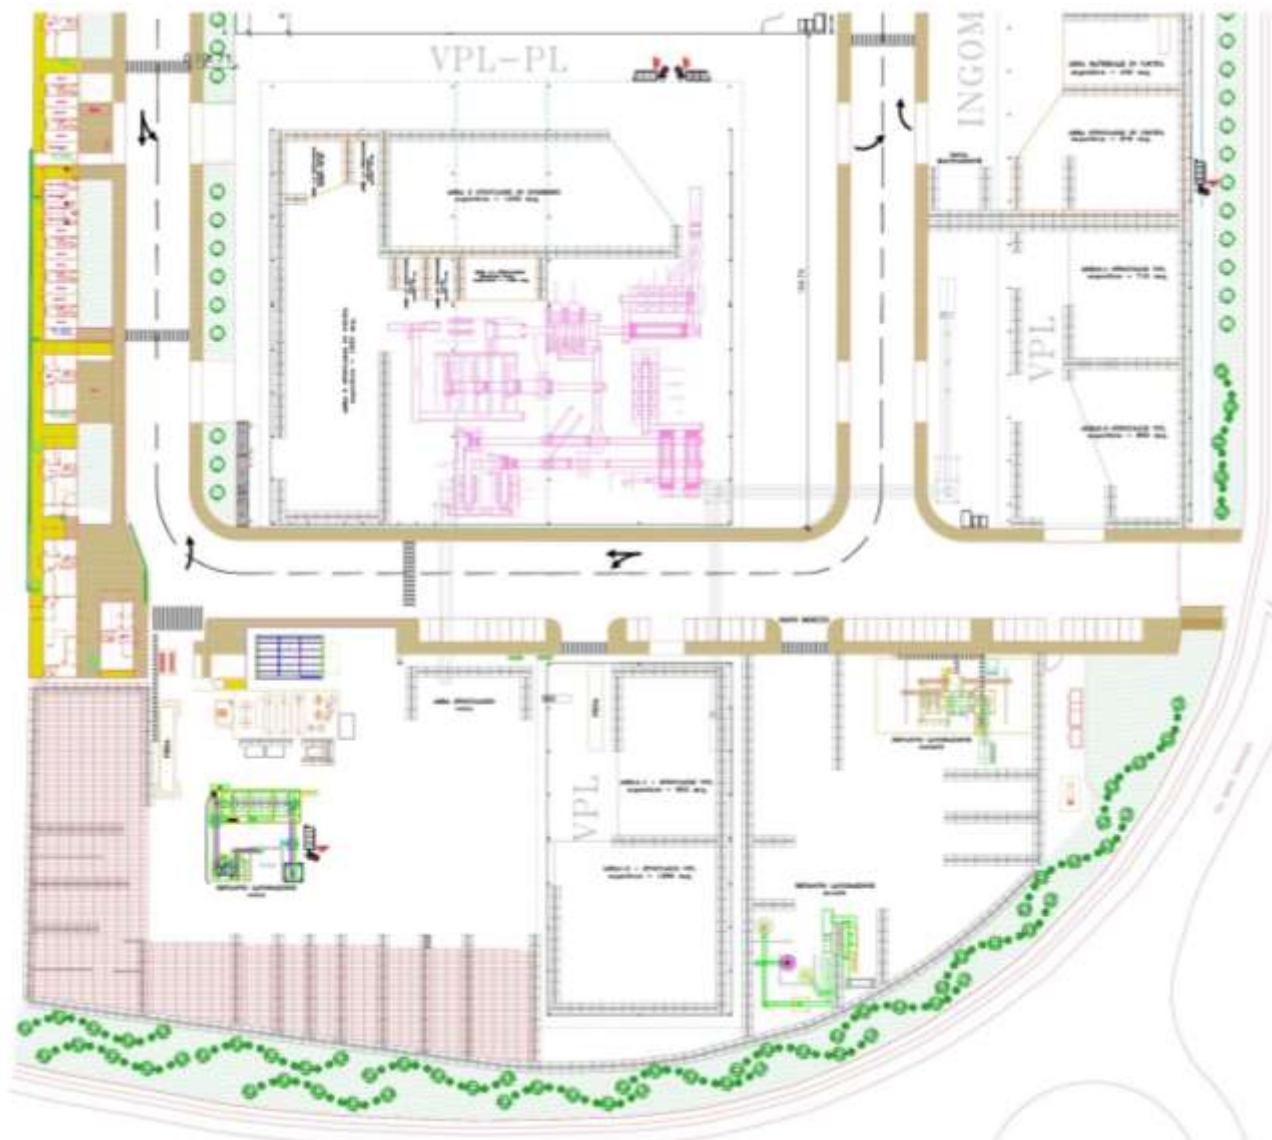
Planimetria Insediamento impianti VPL e PL
